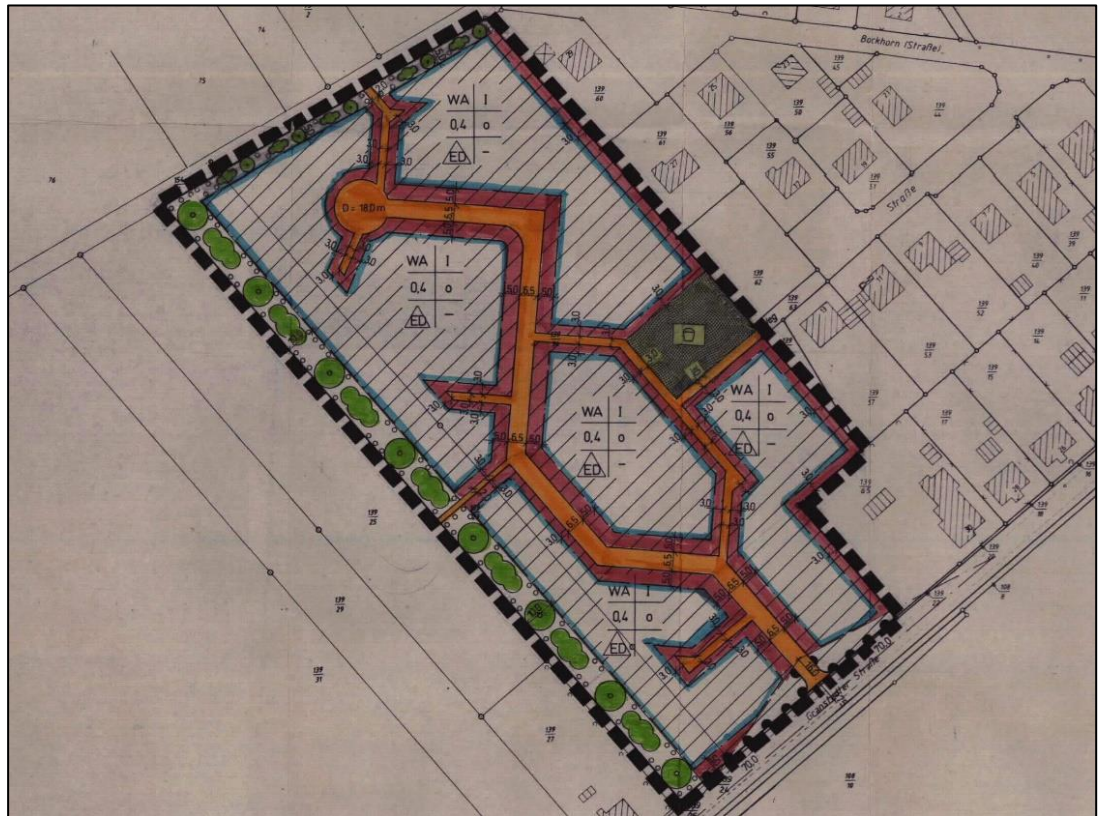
Bebauungsplan Nr. 20 „Granstedter Straße“
